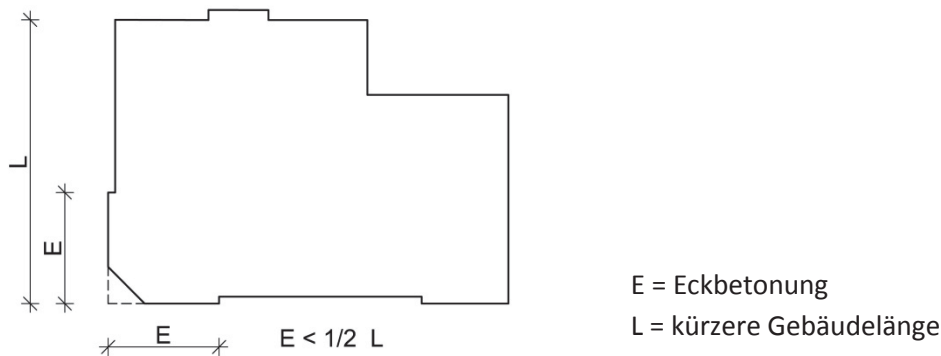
Eckbetonung als schematischer Gebäudegrundriss
